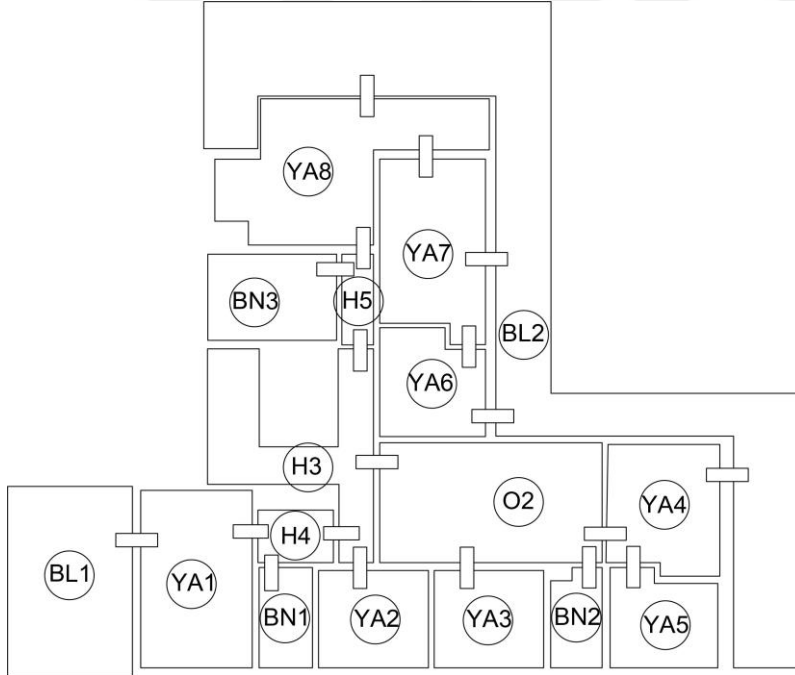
Derviş Manizade Köşkü giriş kat planı
